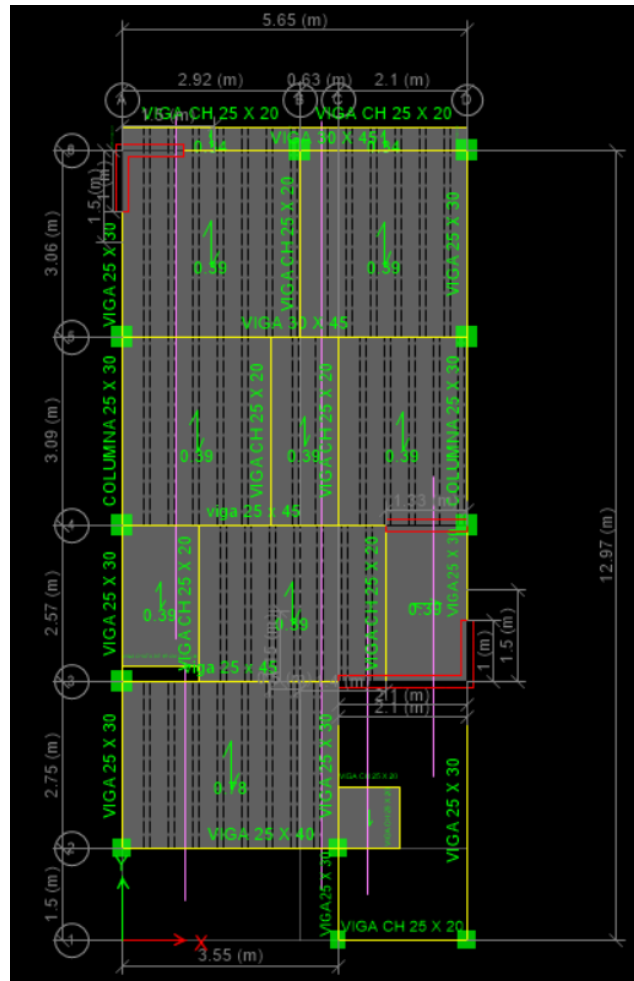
Carga Muerta Sobre Losa Aligerada 20cm Del Primer Nivel.
